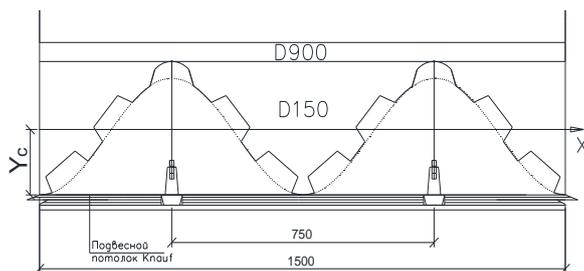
Конструкция перекрытия с несущим профилированным листом
